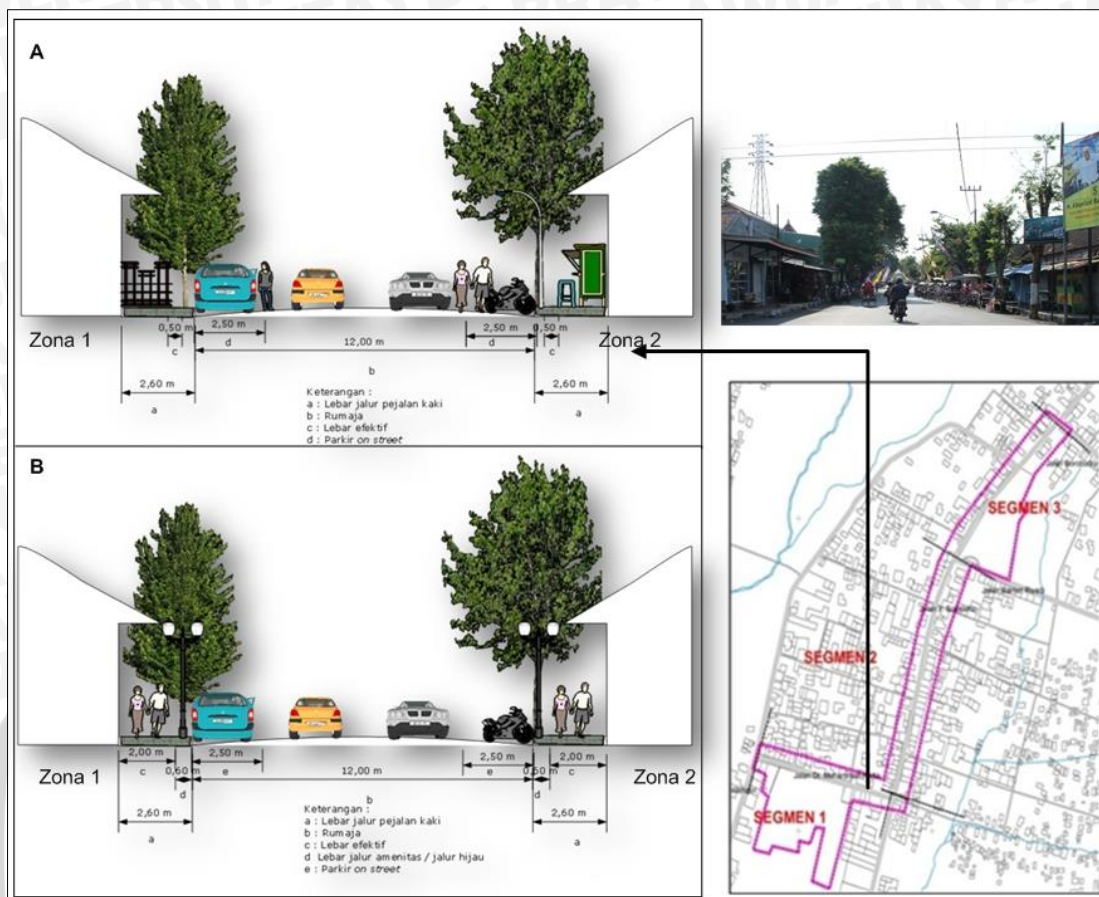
37 Foto Potongan Segmen 1 Sebelum Desain
